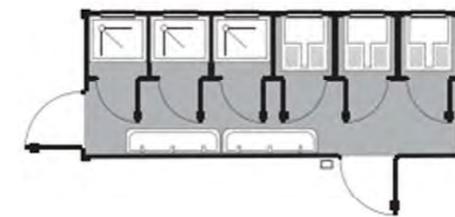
Planimetria del modulo prefabbricato monoblocco dei servizi igienici. Fonte: Autori.
